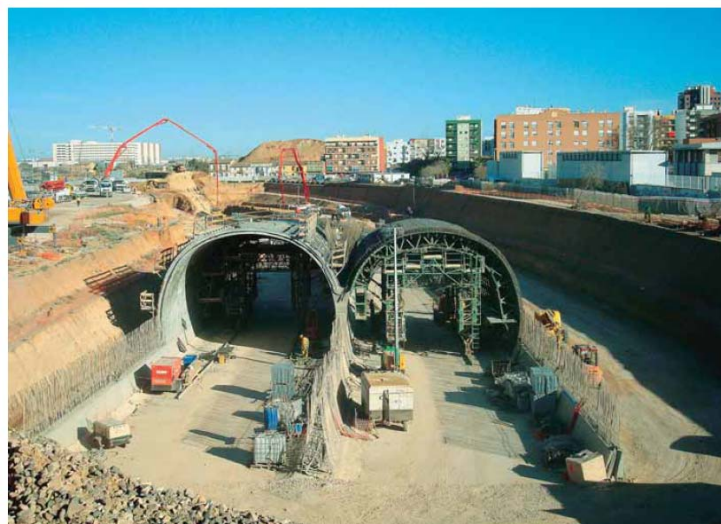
Proceso constructivo del falso túnel de Torrent, primero con el tubo ya ejecutado y luego recubierto.
